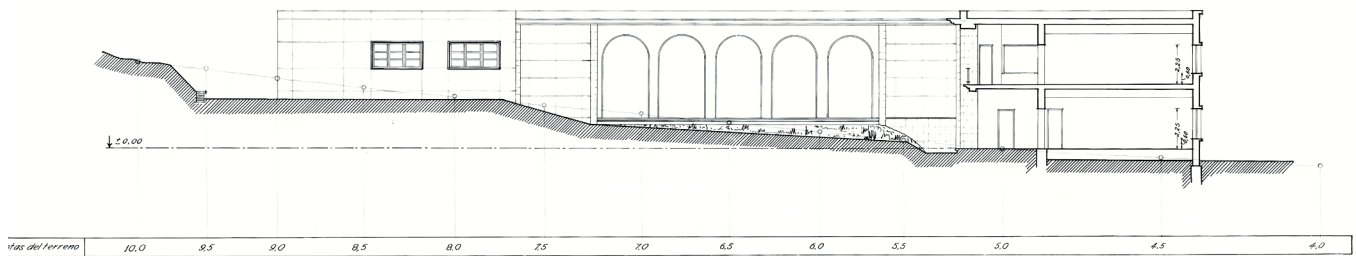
Corte C-C / Sección que atraviesa el bloque de biblioteca, se aprecia el sistema aporticado para salvar la gran luz interior; la composición de los quebra soles, elementos característicos de la biblioteca y de gran aportación para el bloqueo solar hacia el interior; sistema de ventanas con bloques translúcidos. Se plasma la materialidad a ser utilizada en el bloque de ingreso al auditorio y hall principal, así como la cuadrícula en la fachada lateral del auditorio.
